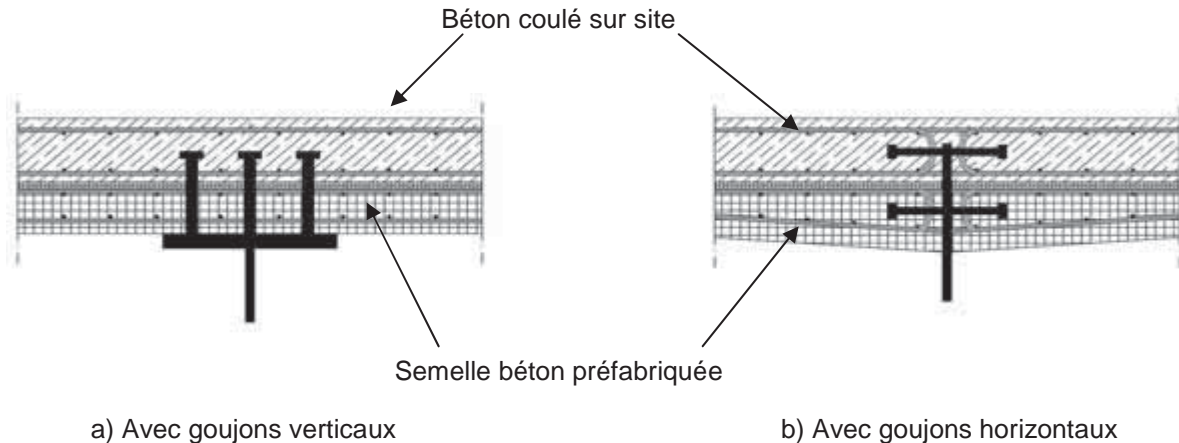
Sections transversales courantes de poutres mixtes préfabriquées avec béton coulé sur chantier.
